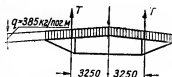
Расчетная схема фермы и схема нагрузок при подъеме.
